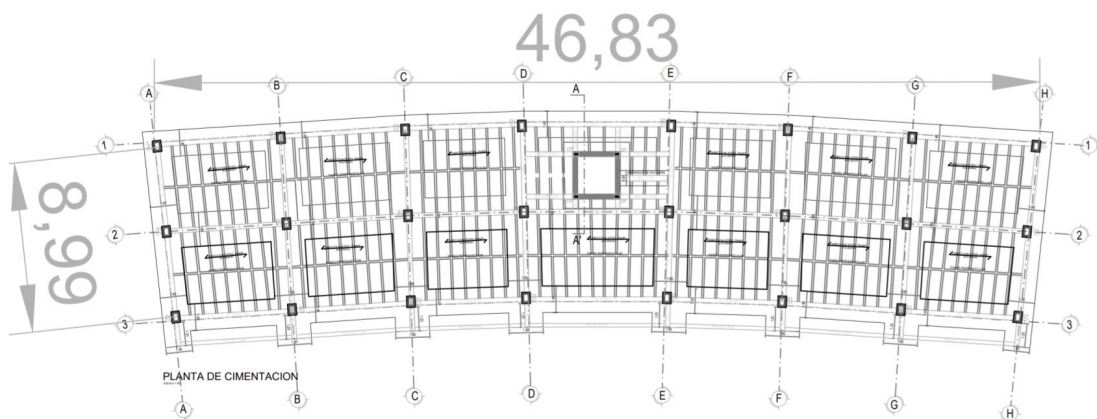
Planta de cimentación con paredes de bloques y vacíos obra OM Center.
